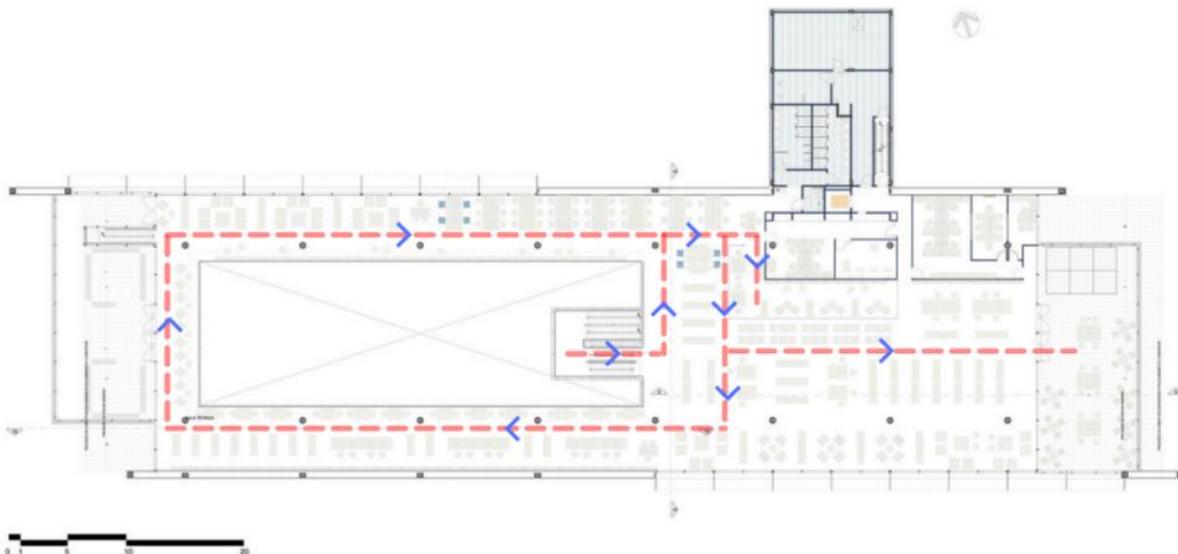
planta térreo com fluxo da visita na Biblioteca São Paulo
